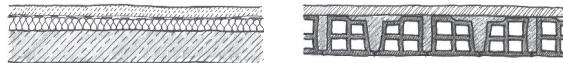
Keller- und Geschossdecken (Quelle: S. Runkel)
